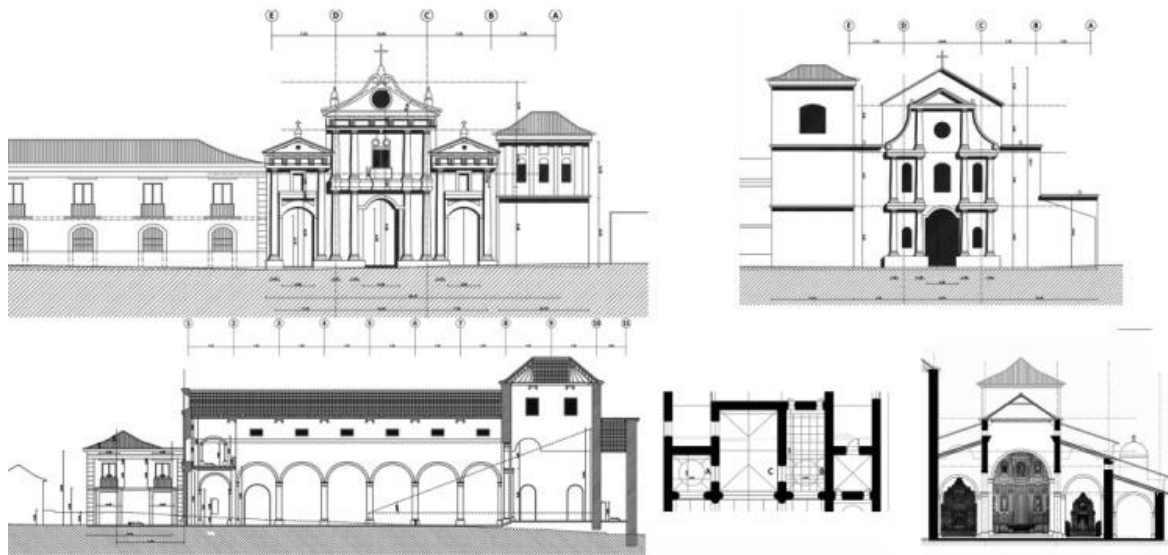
Fachadas, secciones longitudinales y transversales del templo de San Jacinto reconstruido en su aspecto en los siglos XVIII y XIX. Fuente: Elaboración propia.
